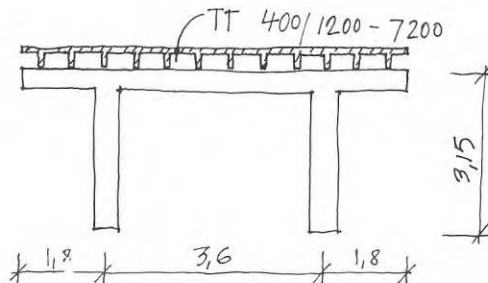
Prefabricerad ram av betong med rektangulärt tvärsnitt
